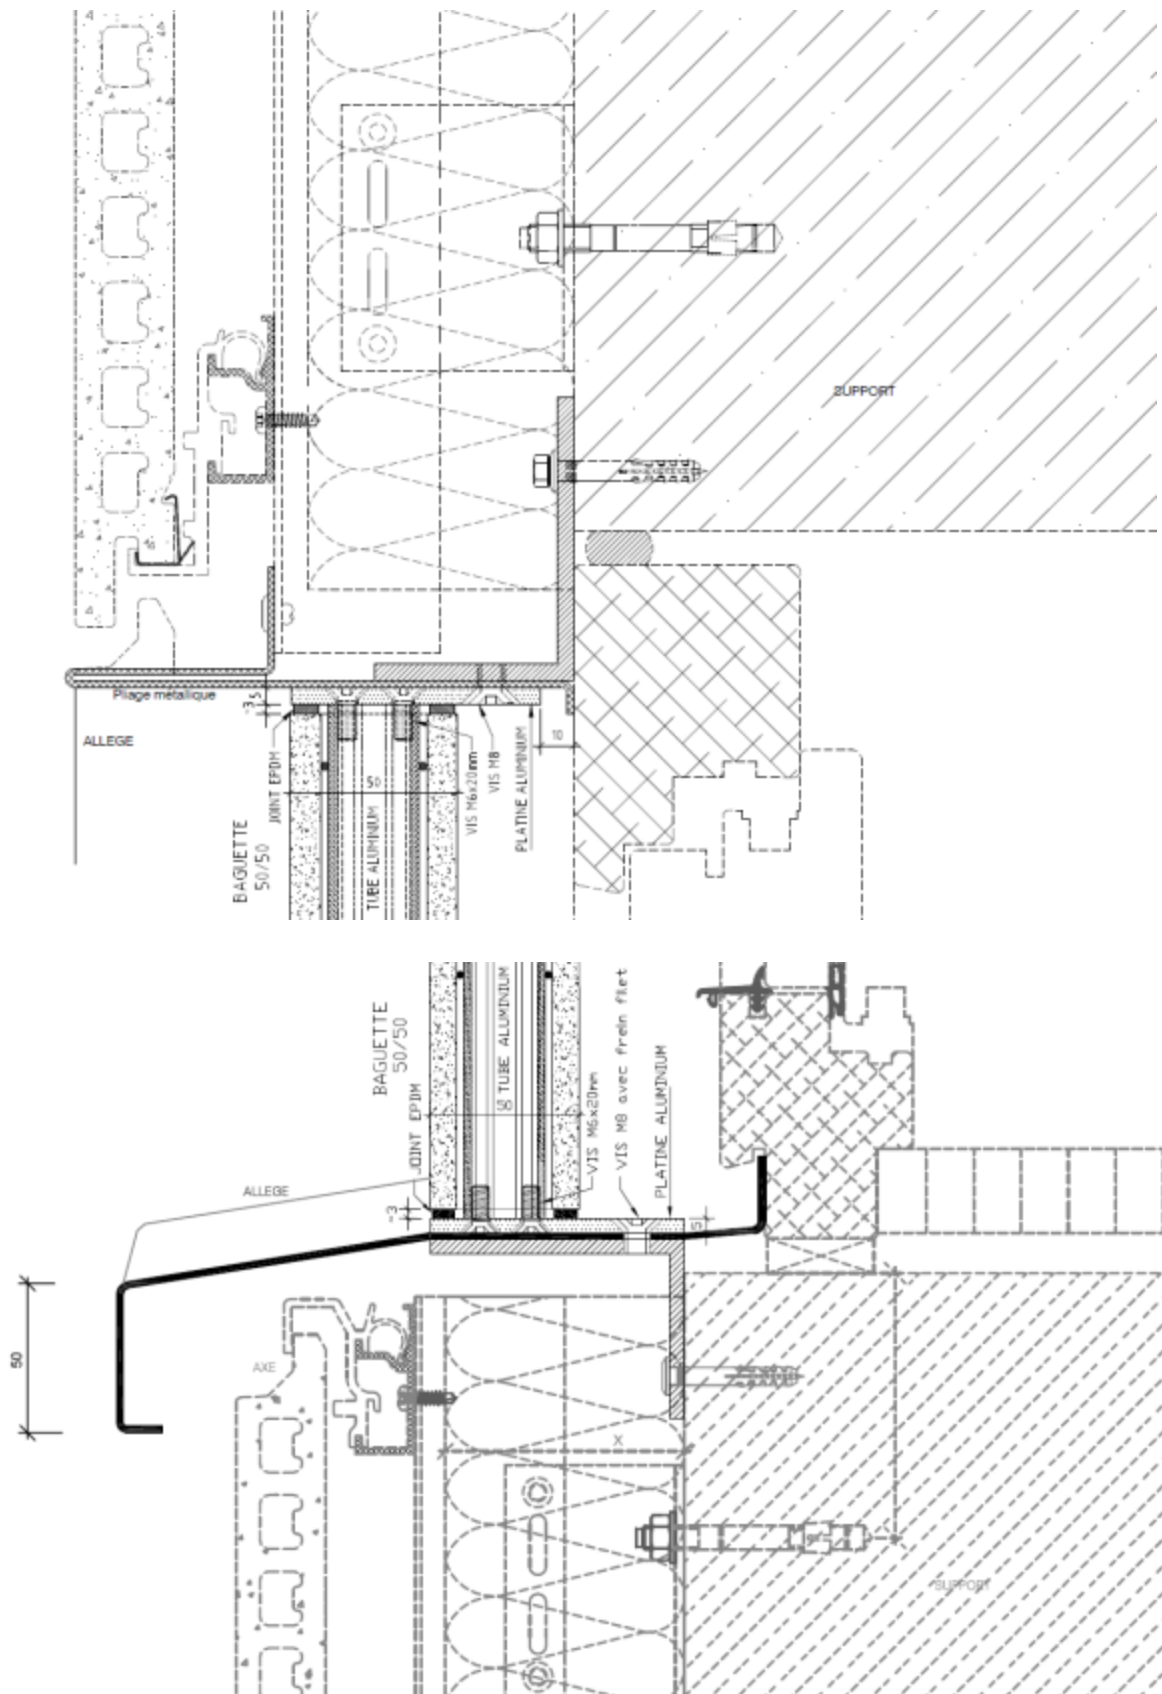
Exemple de pose avec fixation « back fixing » et tube traversant
